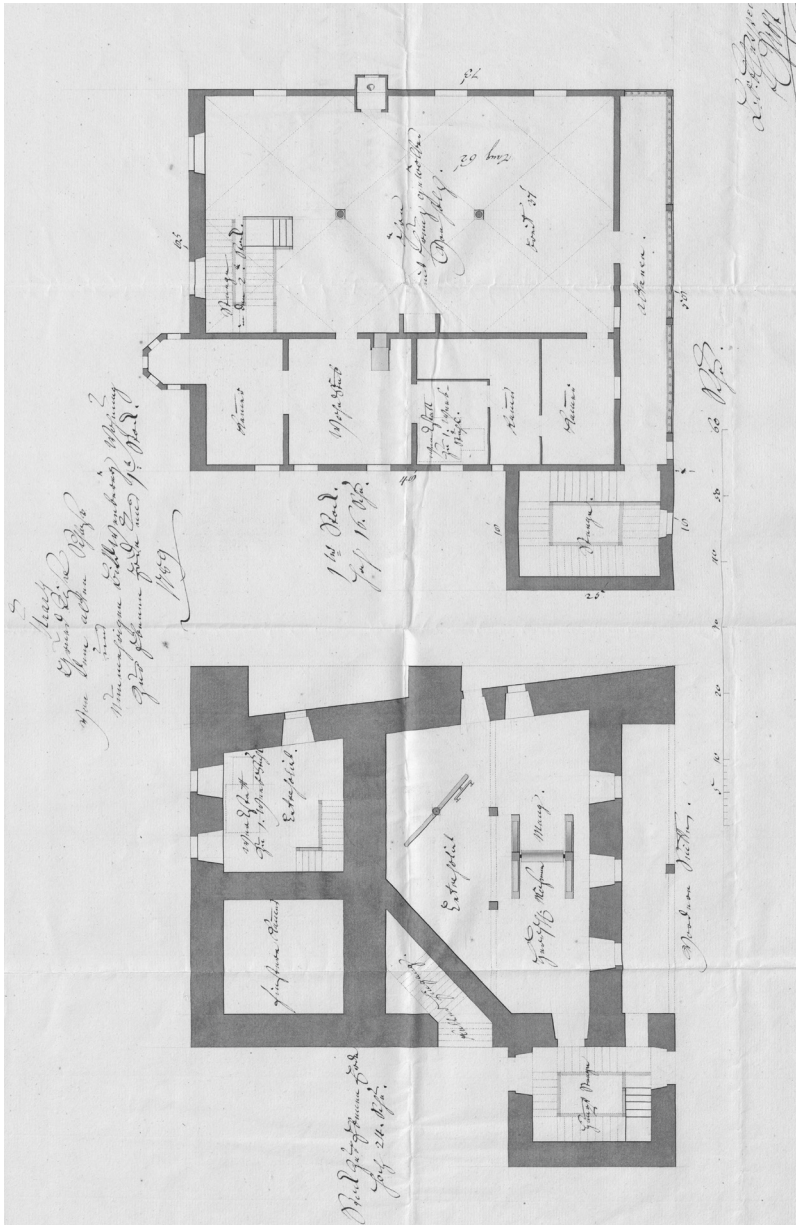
Altes Schloss Urach, Grundriss Erdgeschoss und erstes Obergeschoss von Johann Adam Groß d.J., 1789 (Vorlage: HStAS A 248 Bü 289).
